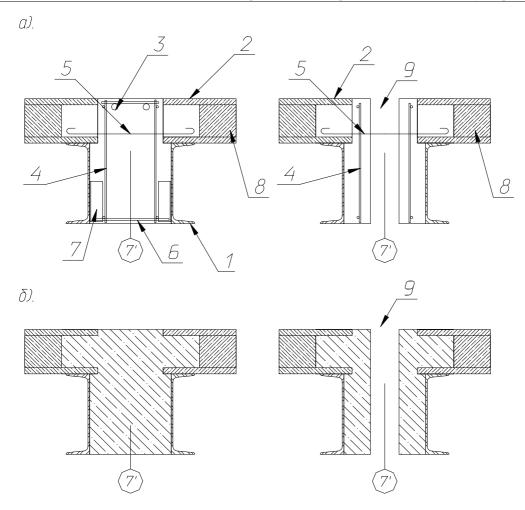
Отдельные узлы стального каркаса на стадии монтажа
